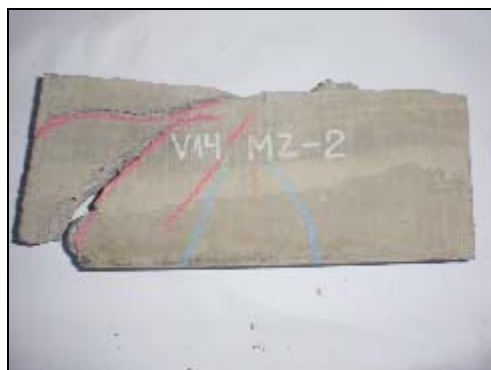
14 Grietas viga 3 modelo 2
